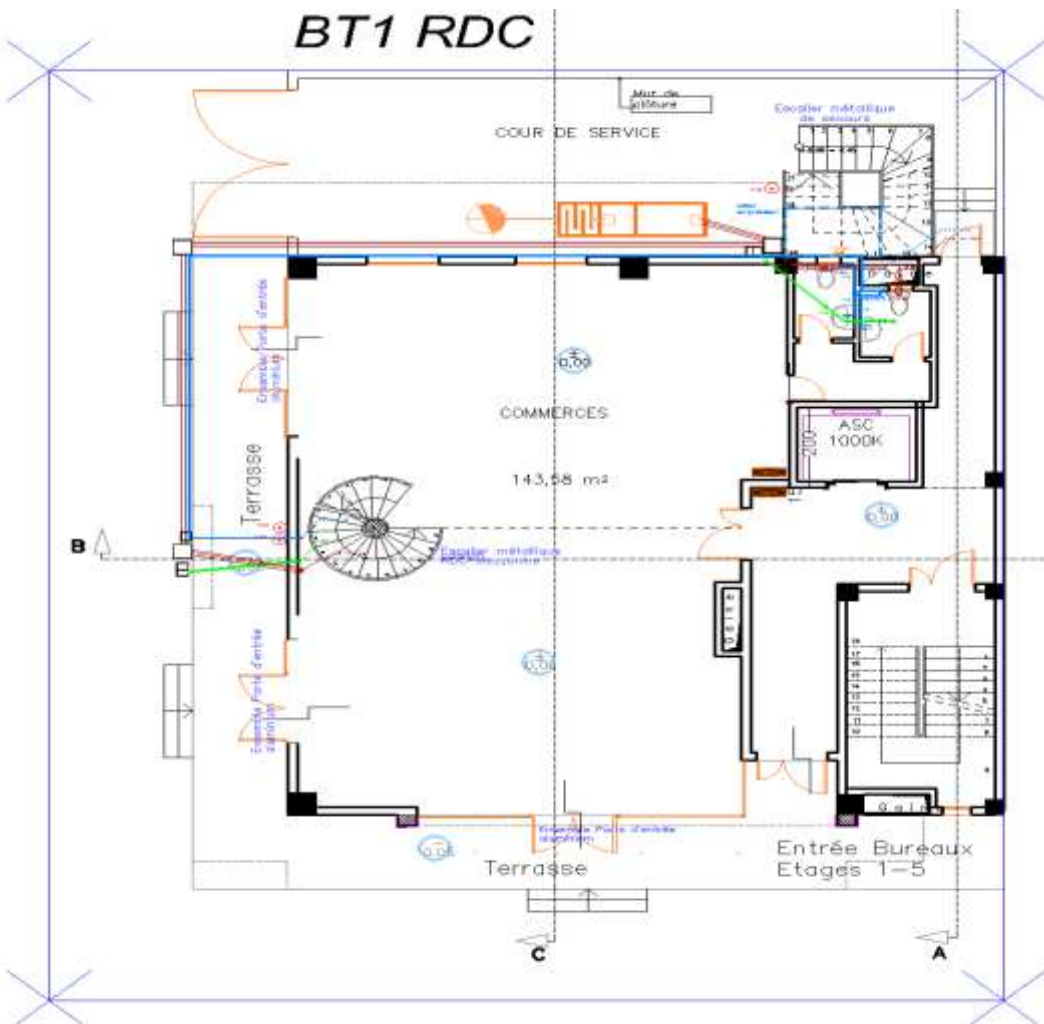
Plan du Bâtiment Tertiaire 1 niveau RDC
